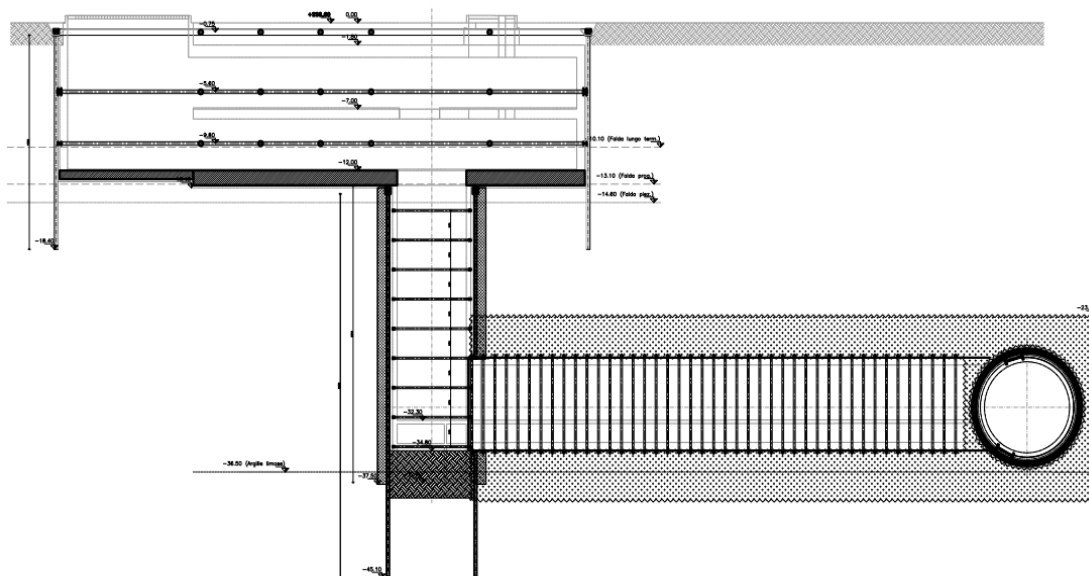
Esempio di opere di contenimento degli scavi per cabina tecnica e pozzo verticale – Sezione longitudinale.
